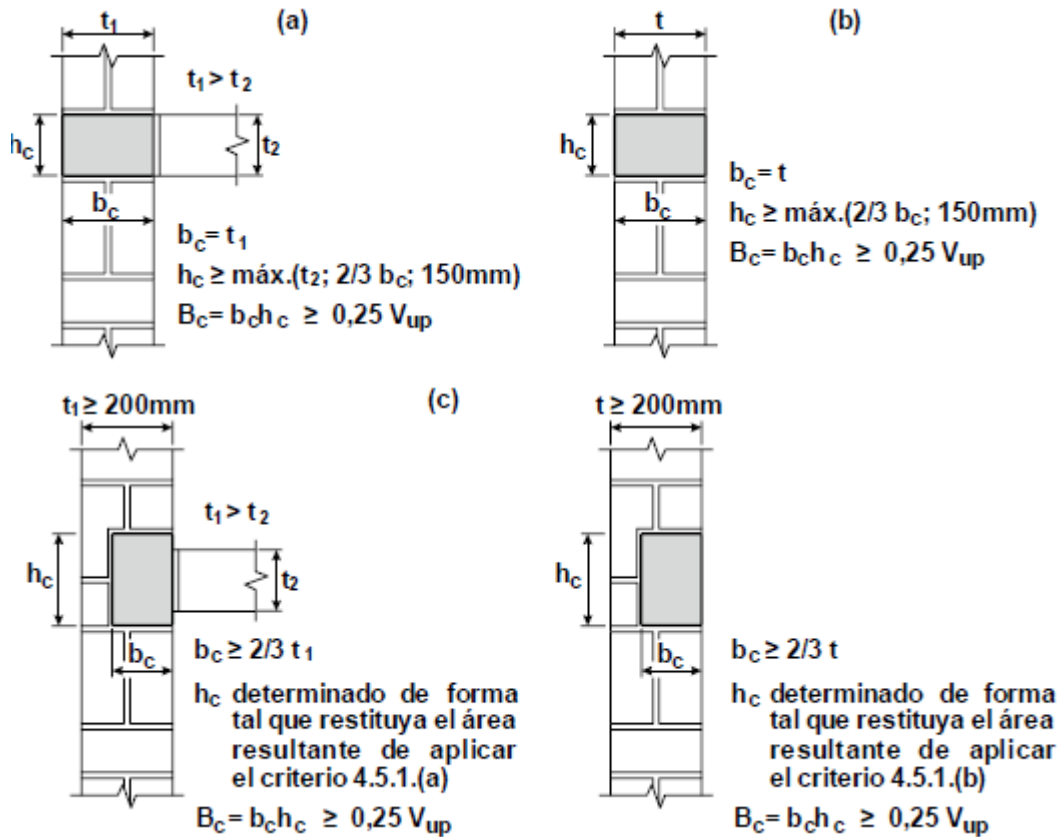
Sección transversal de columnas de encadenado de hormigón armado.
